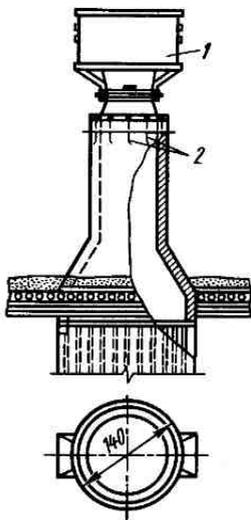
Вентиляционная шахта для объединенных каналов;
